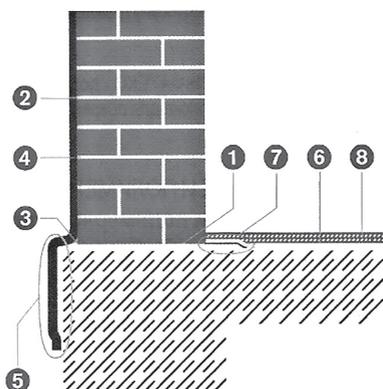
Гидроизоляция с использованием ШЛАМОВ К11:
